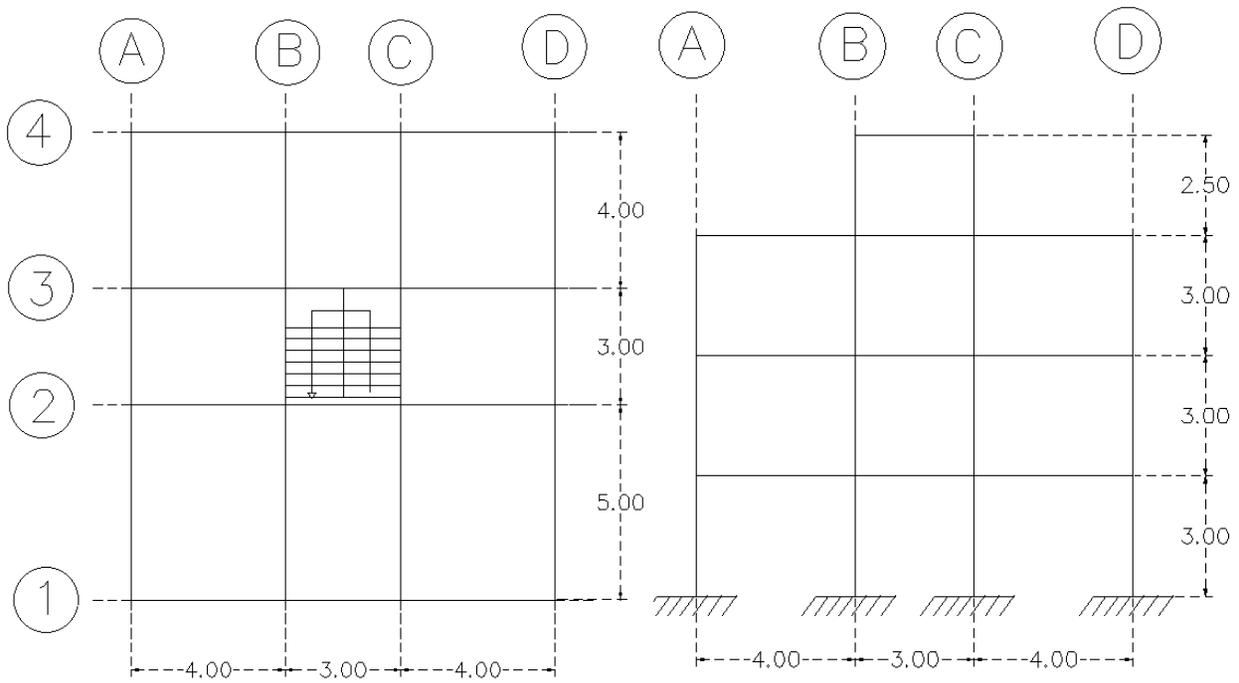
Vista en planta y elevación frontal de la edificación de tres plantas.
